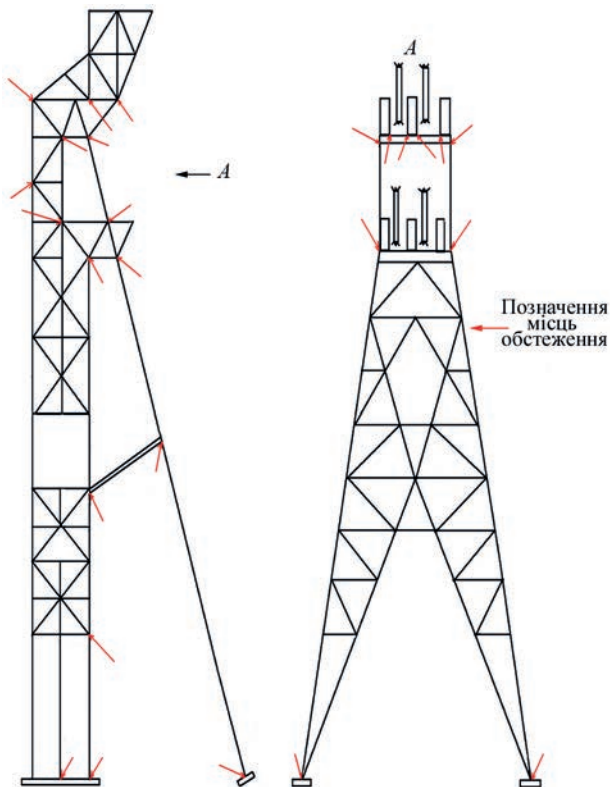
Місця обстеження металоконструкцій копра станкової системи
